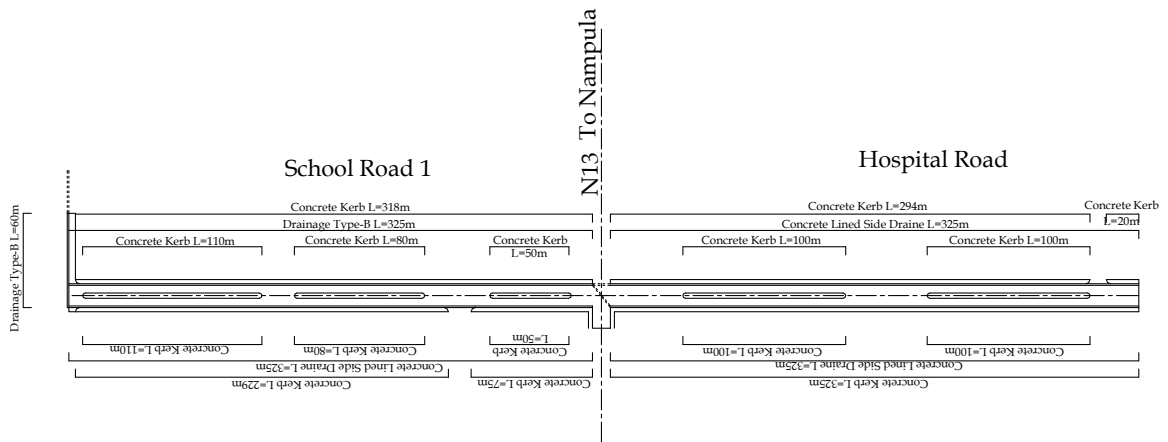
Plano Esquemático das Estradas a Reabilitar
